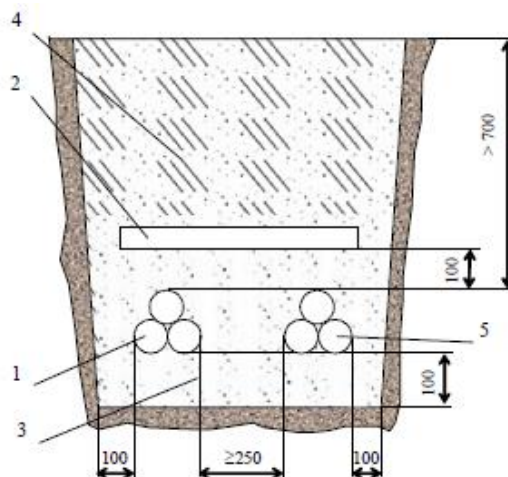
1 - кабель 20 кВ; 2 - залізобетонна плита; 3 - піщано-гравійна суміш; 4 - засипний ґрунт; 5 - кабель 35 кВ
